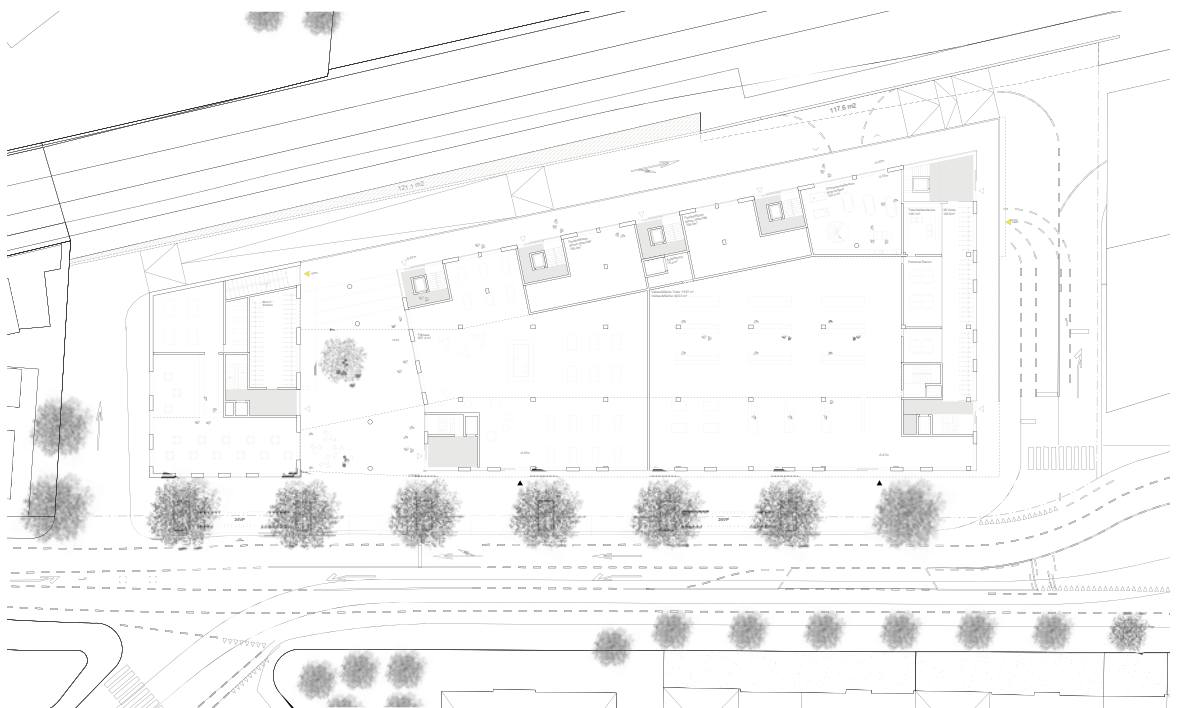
Situation, Erschliessung und konzeptioneller Grundriss Erdgeschoss (Strassenniveau)
